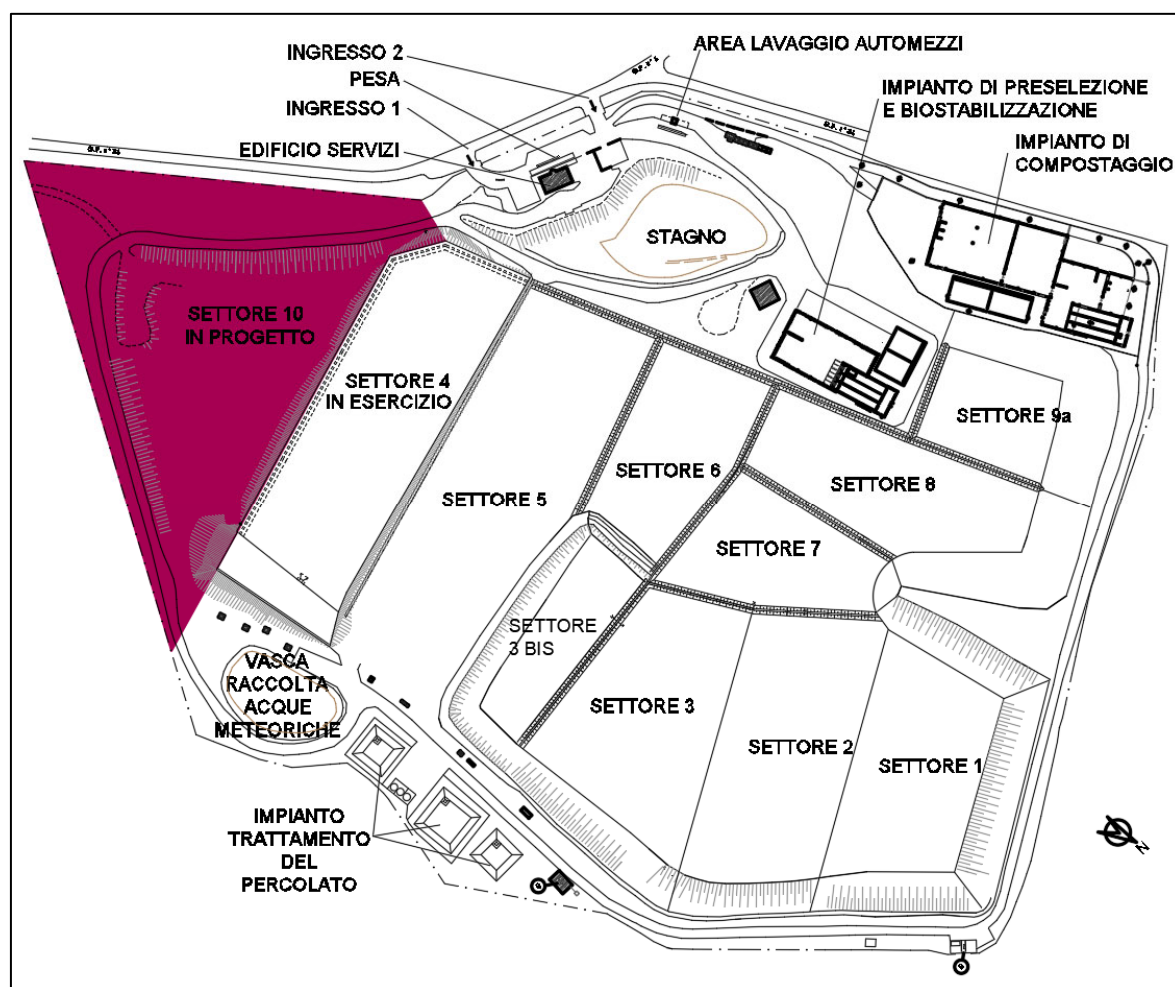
Planimetria generale impianto - Stralcio della planimetria di progetto
